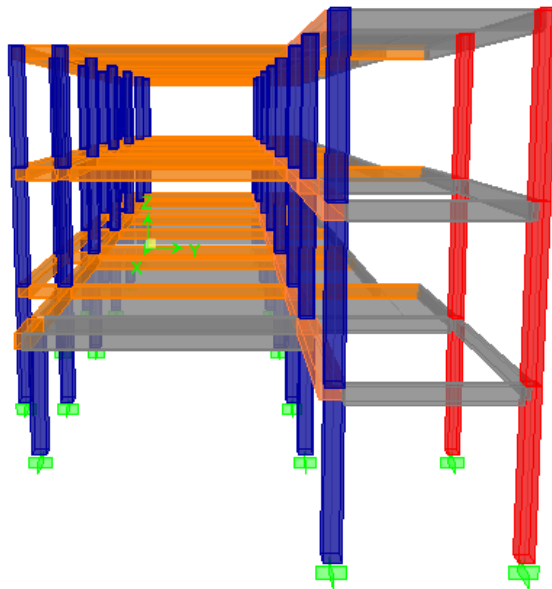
Sistema Reforzado con Pórtico Adosado – Vista 4
